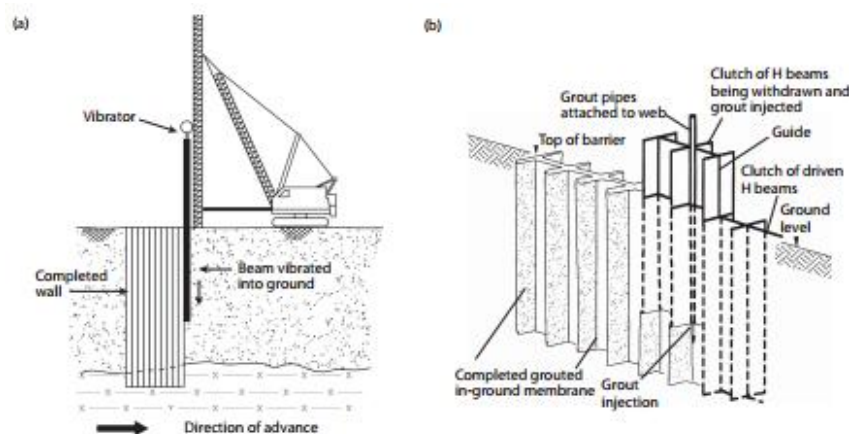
Ilustração do processo construtivo de paredes membranas de grout (fonte: Groundwater Lowering in Construction [4])
